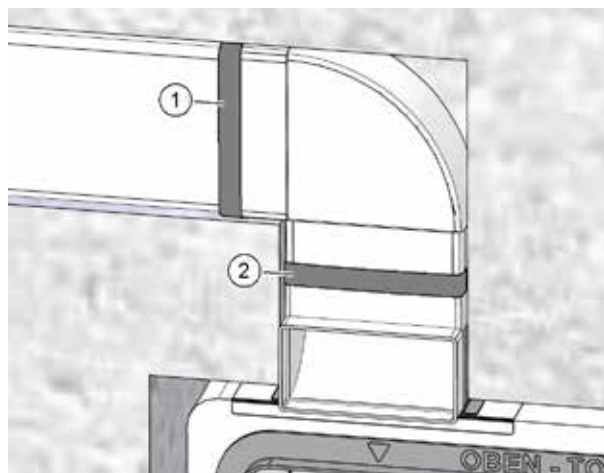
Fissaggio dell'allacciamento del canale piatto con nastro sigillante
